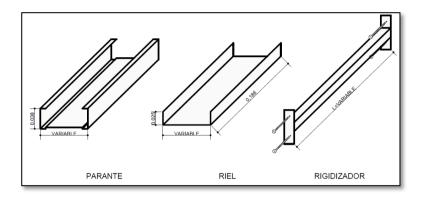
Perfilería metálica utilizada en el sistema steel framing.
